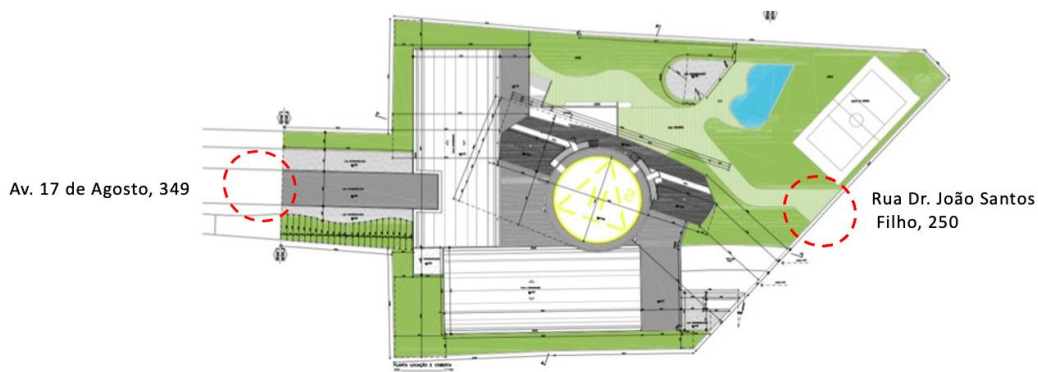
Planta de locação do edifício Alameda Casa Forte. Fonte: Construtora Moura Dubeux - Adaptado pela Autora (2018).
